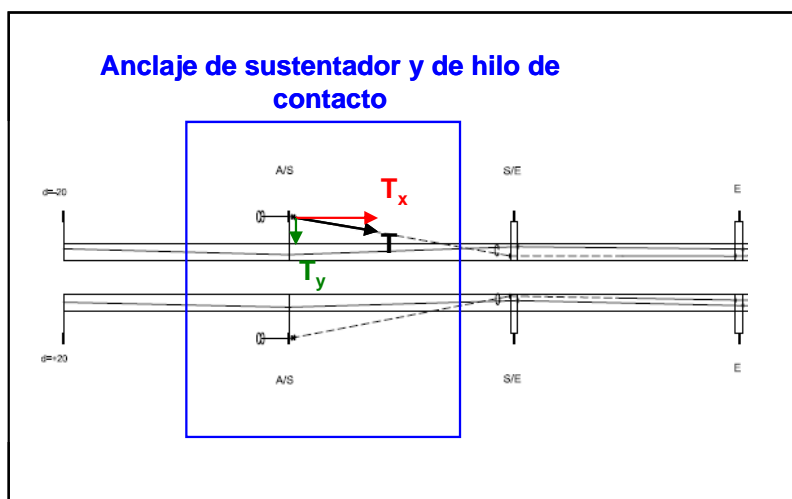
Fuerza de atirantado en el anclaje de seccionamiento
